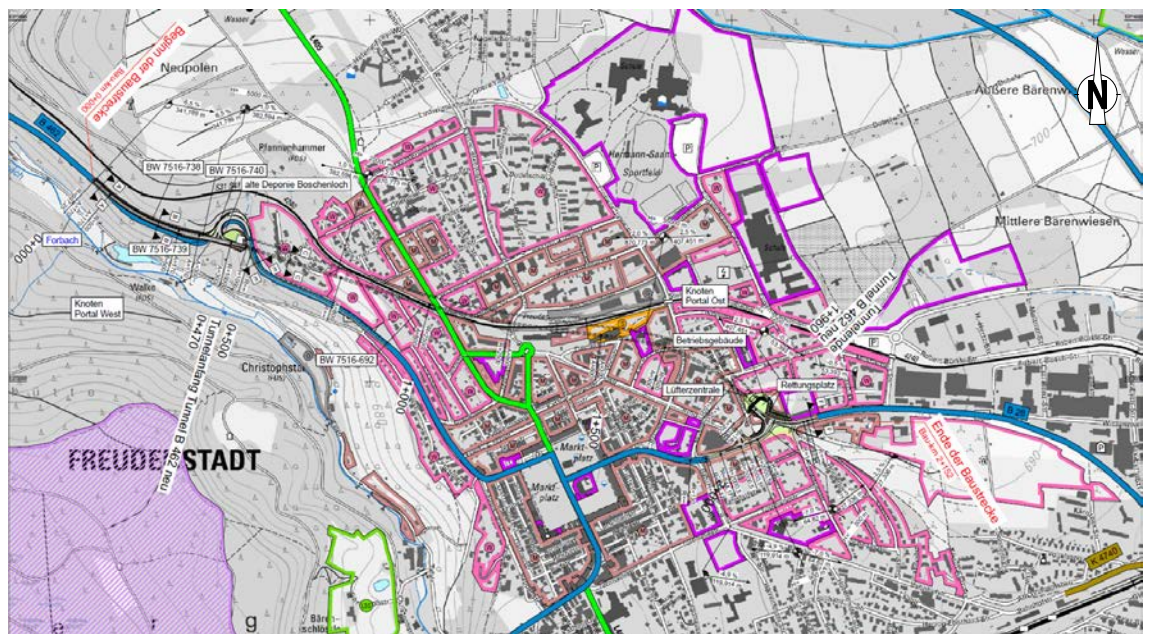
Lageplan der Straßenplanung B 28 / B 462 Freudenstadt, BA IV.1 Unterführung Stadt Freudenstadt [12].
